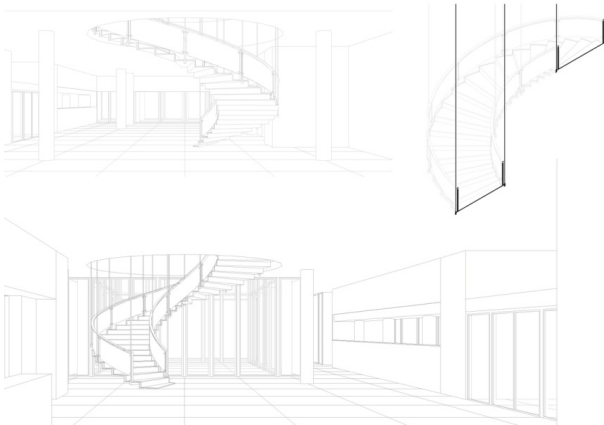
Detalle constructivo en axonométrico y vistas frontales, de la escalera, contrapuestas de la entrada y salida del edificio.
